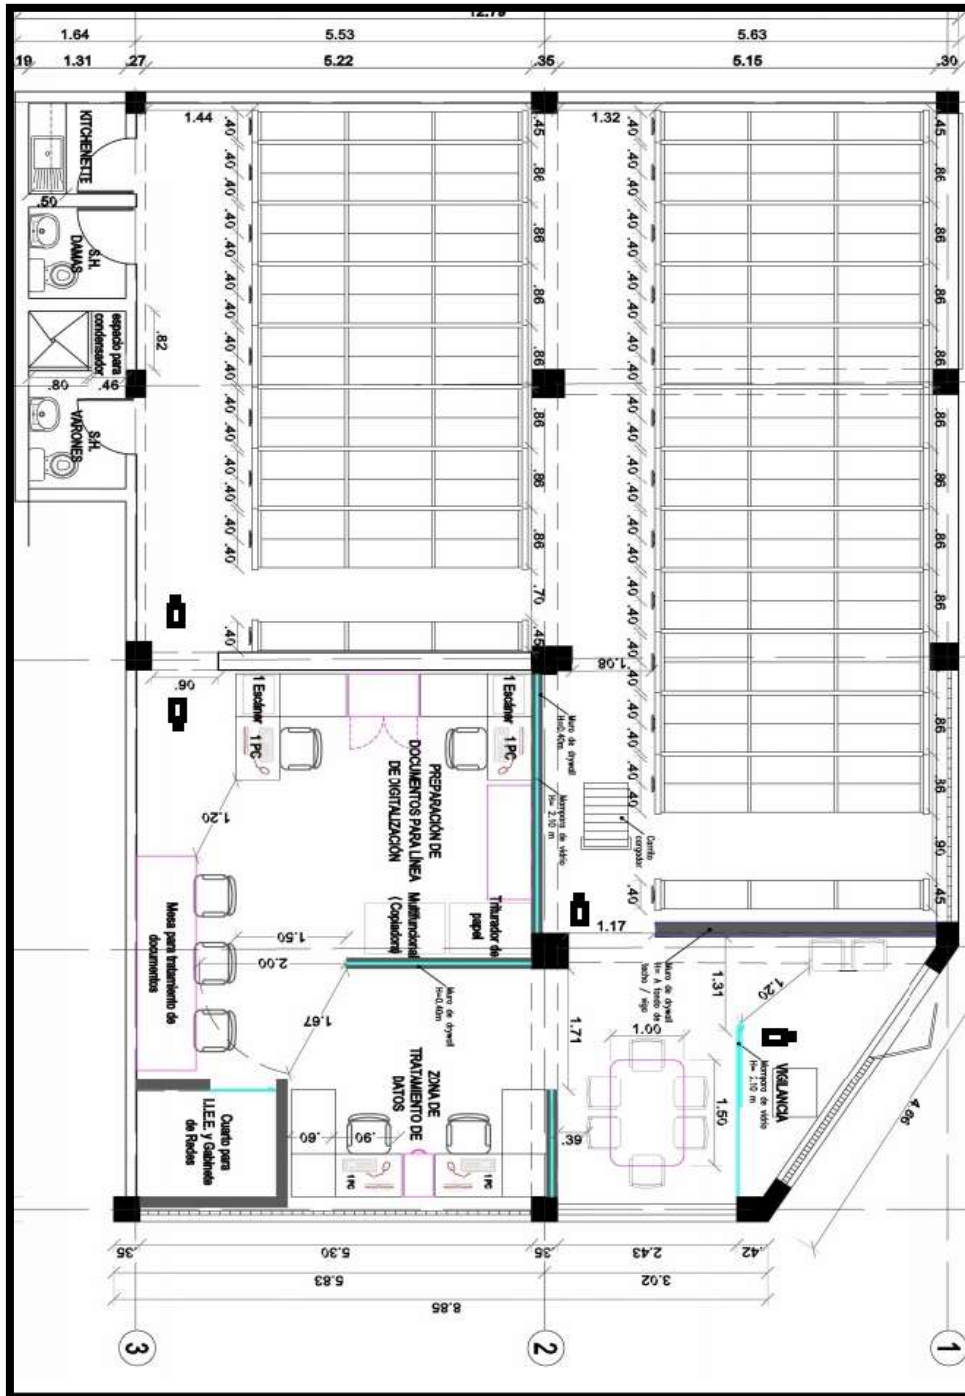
Plano de distribución de oficinas y área 6004.
